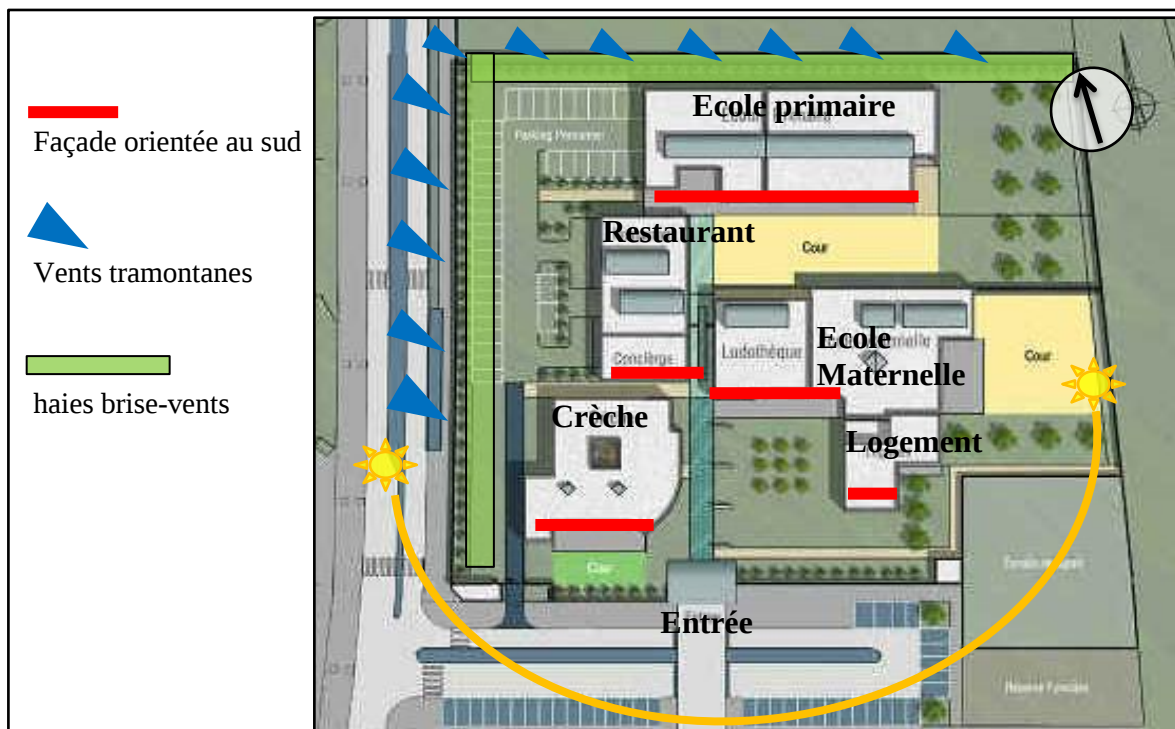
Plan de masse (Source: outilssolaires.com)
